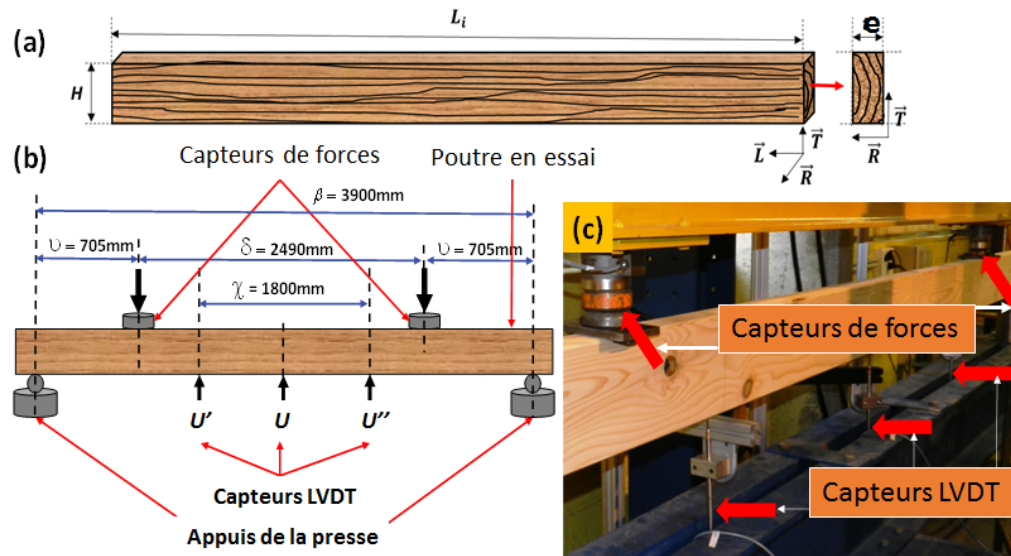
Dispositif expérimental des essais statiques de flexion 4-points sur les PNE : (a) Configuration géométrique de la poutre ; (b) Schéma du dispositif expérimental ; (c) Poutre en essai.
